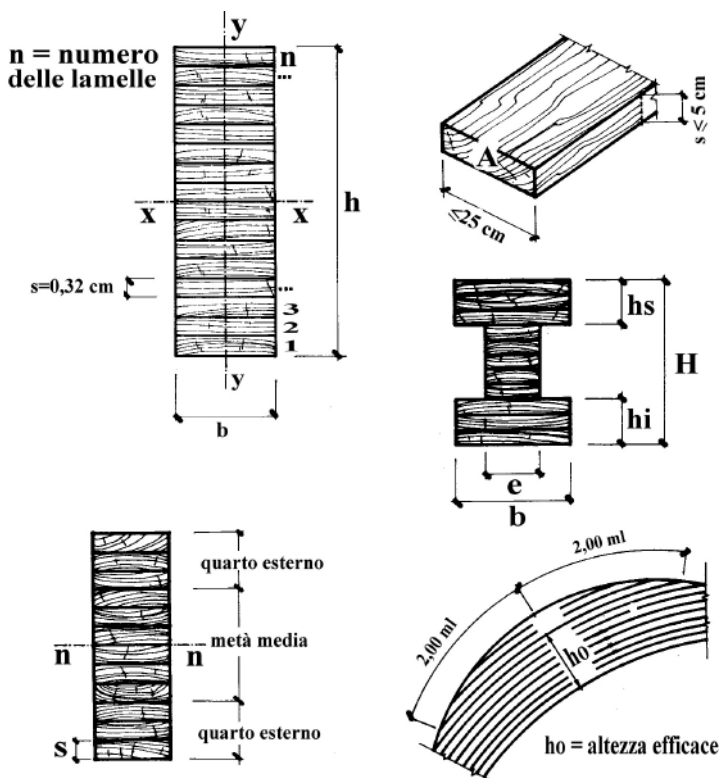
Sezioni geometriche rettangolari per travi in legno lamellare
